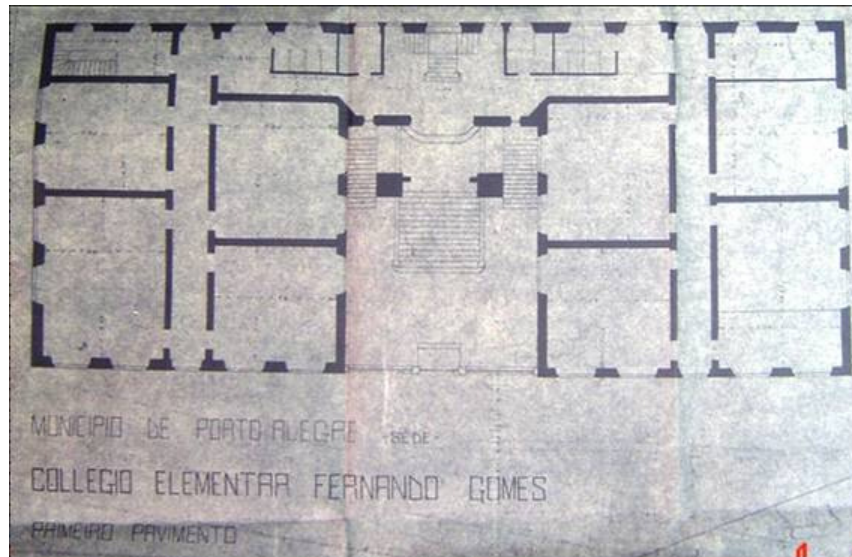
Planta baixa do 1º pavimento do Colégio Elementar Fernando Gomes - 1913.
